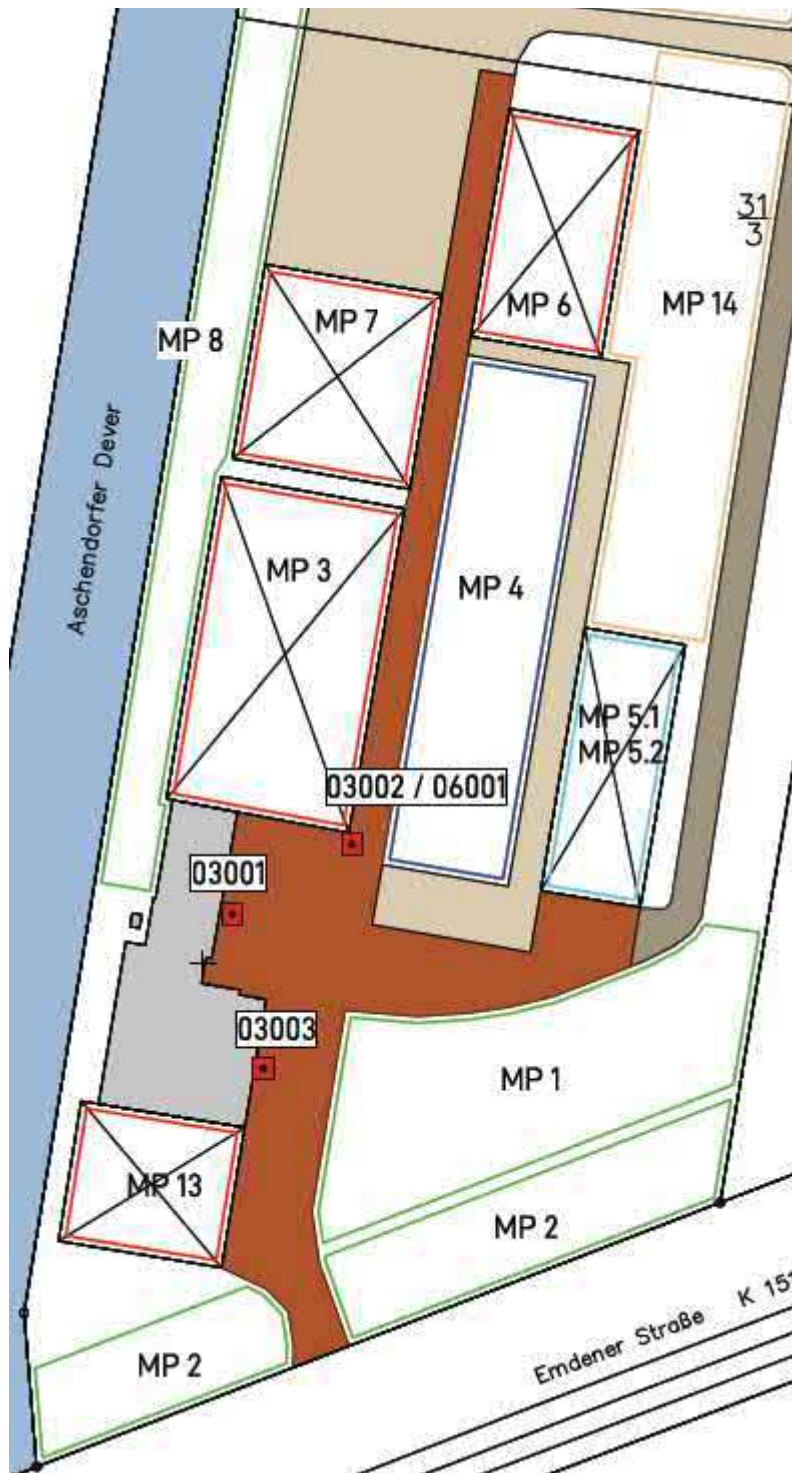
südliche Betriebsfläche der Stadtgärtnerei mit baulichen Anlagen; Bewertungsfläche gekennzeichnet
